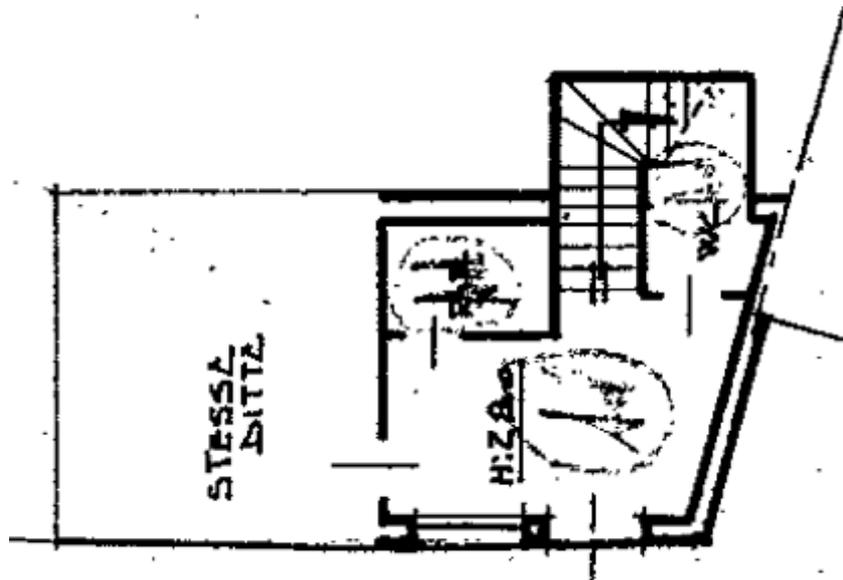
Planimetria catastali dei beni, sub. 1 (p.t.).
